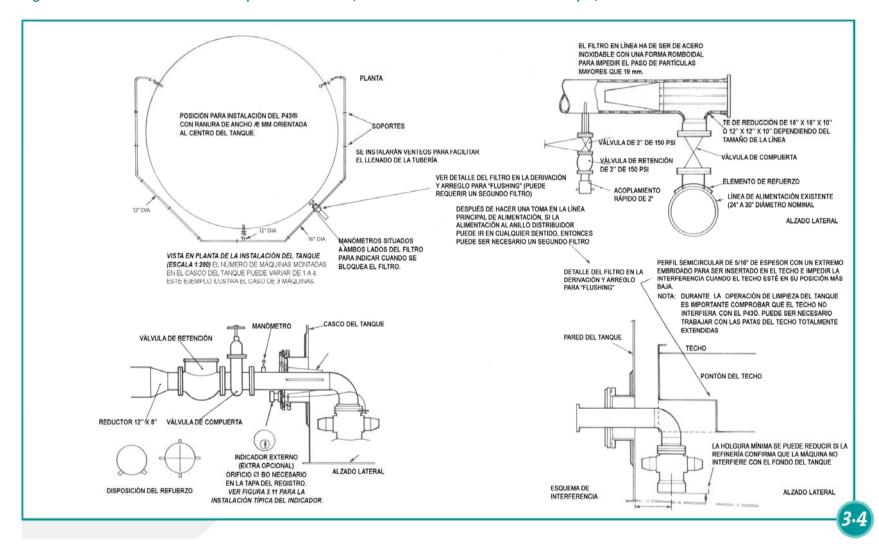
Detalles del montaje del anclaje (P43® montado en el centro)
